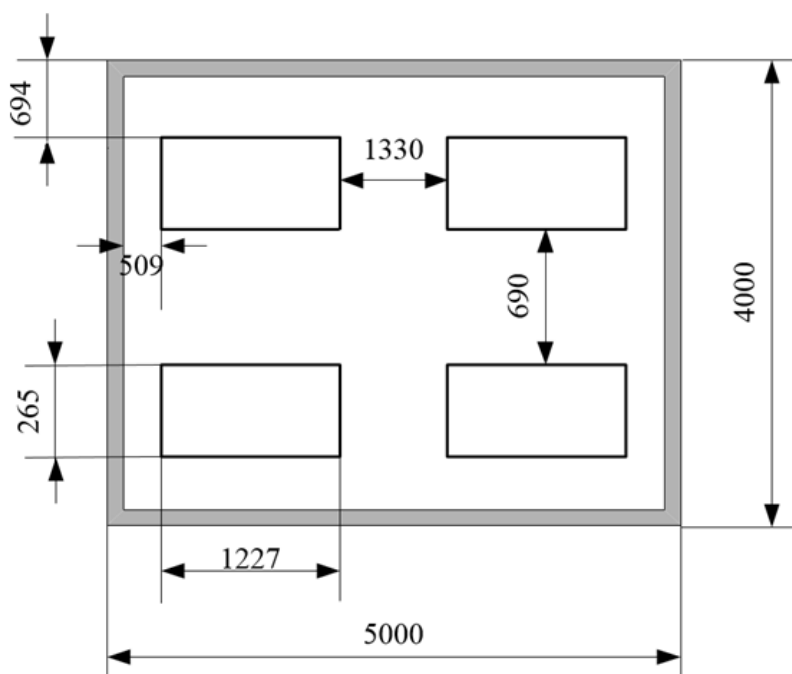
План помещения и размещения светильников с люминесцентными лампами
